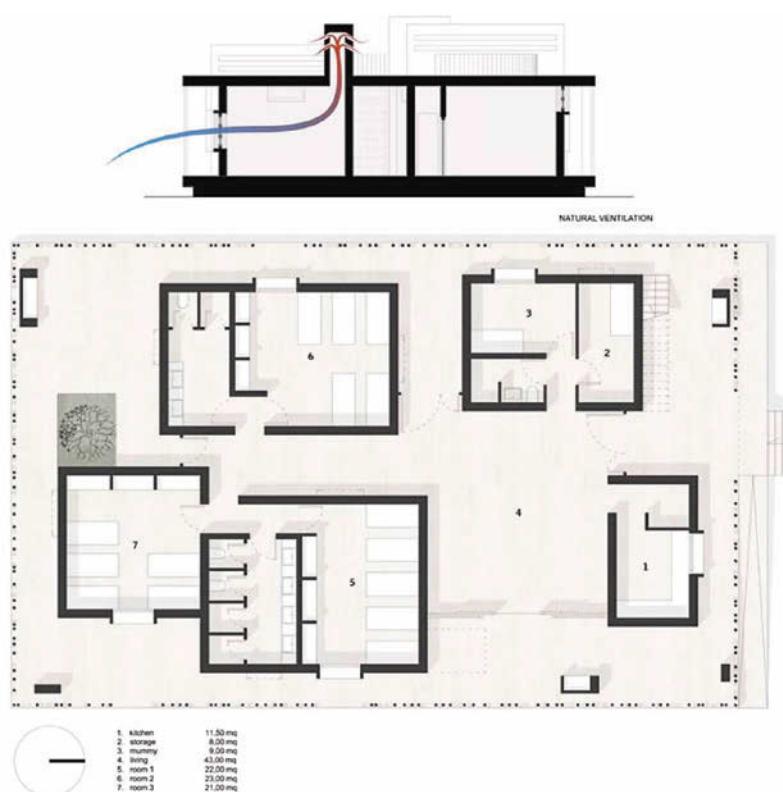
/ Casa Rana. Esquema del sistema de ventilación. Planta baja en la que se aprecia la organización de volúmenes que generan espacios intermedios bajo una única cubierta con galería perimetral.
